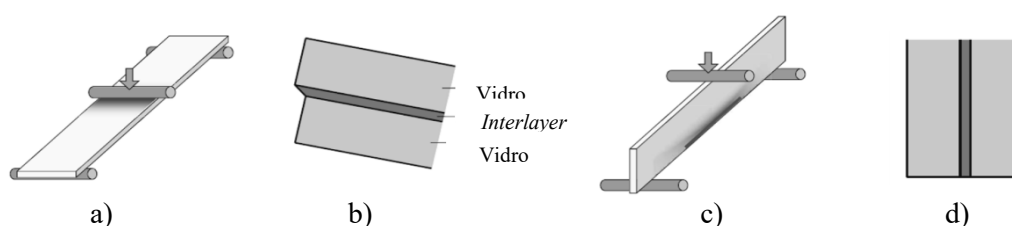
Esquema estrutural do elemento viga e respetiva deformação da secção transversal: (a-b) posição ao baixo; (c-d) posição ao alto (adaptado de Belis *et al.*, 2009)
